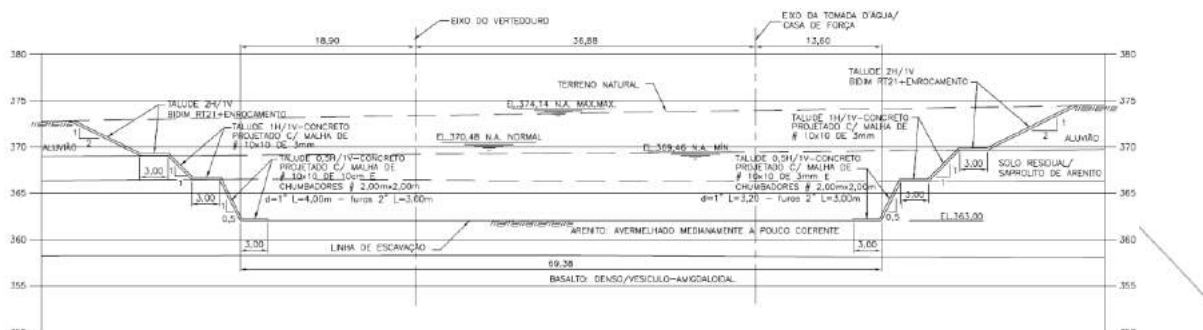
Seções Típicas de Escavação (vista da barragem por jusante).
